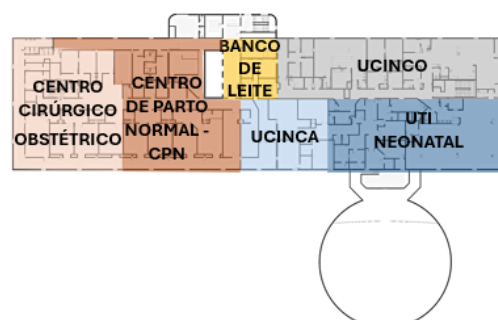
SETORIZAÇÃO BLOCO 1 - 3º PAVIMENTO
